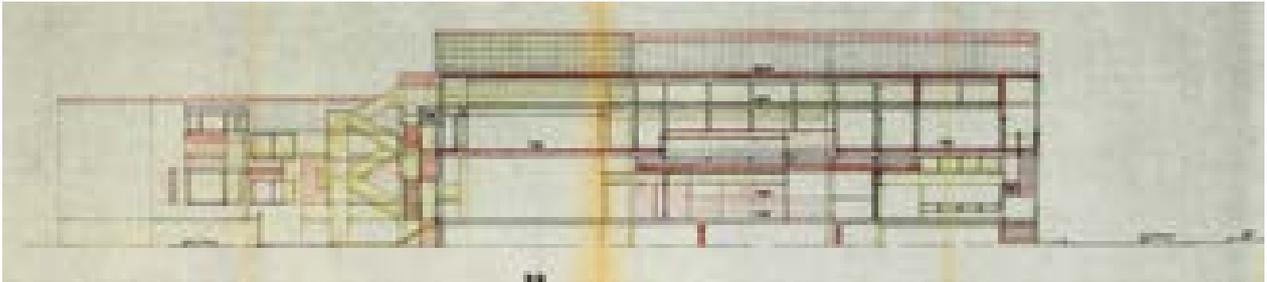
Sezione DD, stato sovrapposto –12/09/1984 (AABS-1996.758)
